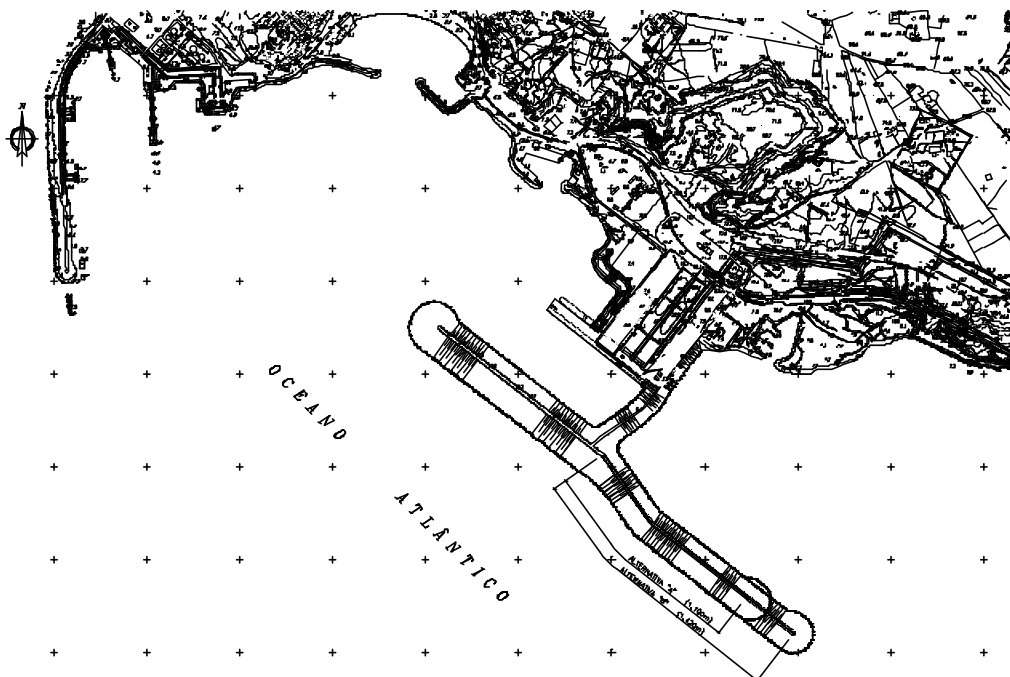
Planta geral da obra do molhe (Alternativas A e B)
